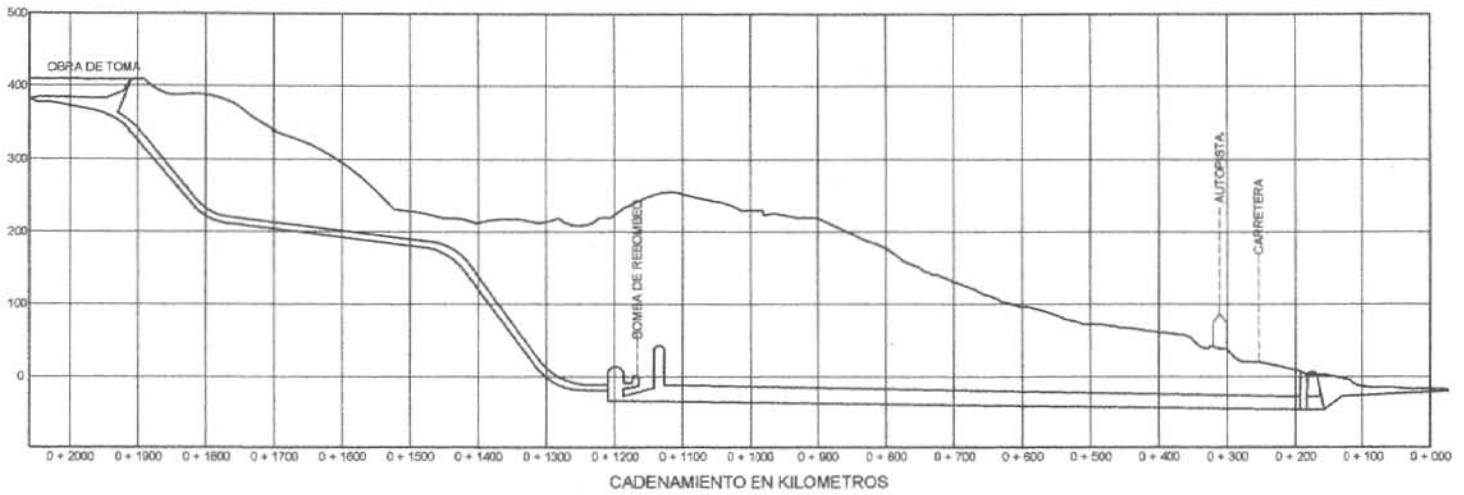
Alternativa con casa de máquinas subterránea
